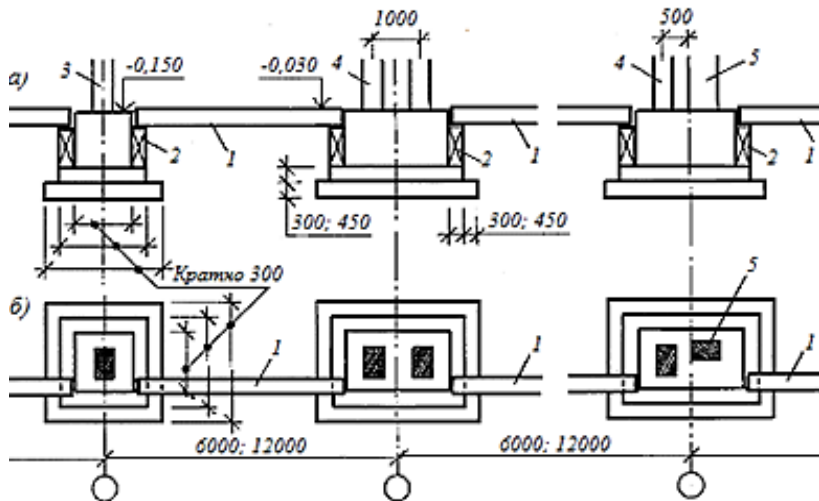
Фрагменти спирання балок на уступи фундаментів: *а* – боковий вигляд; *б* – план; *1* – фундаментні балки; *2* – бетонні стовпчики (припливи); *3, 4* та *5* – колони
